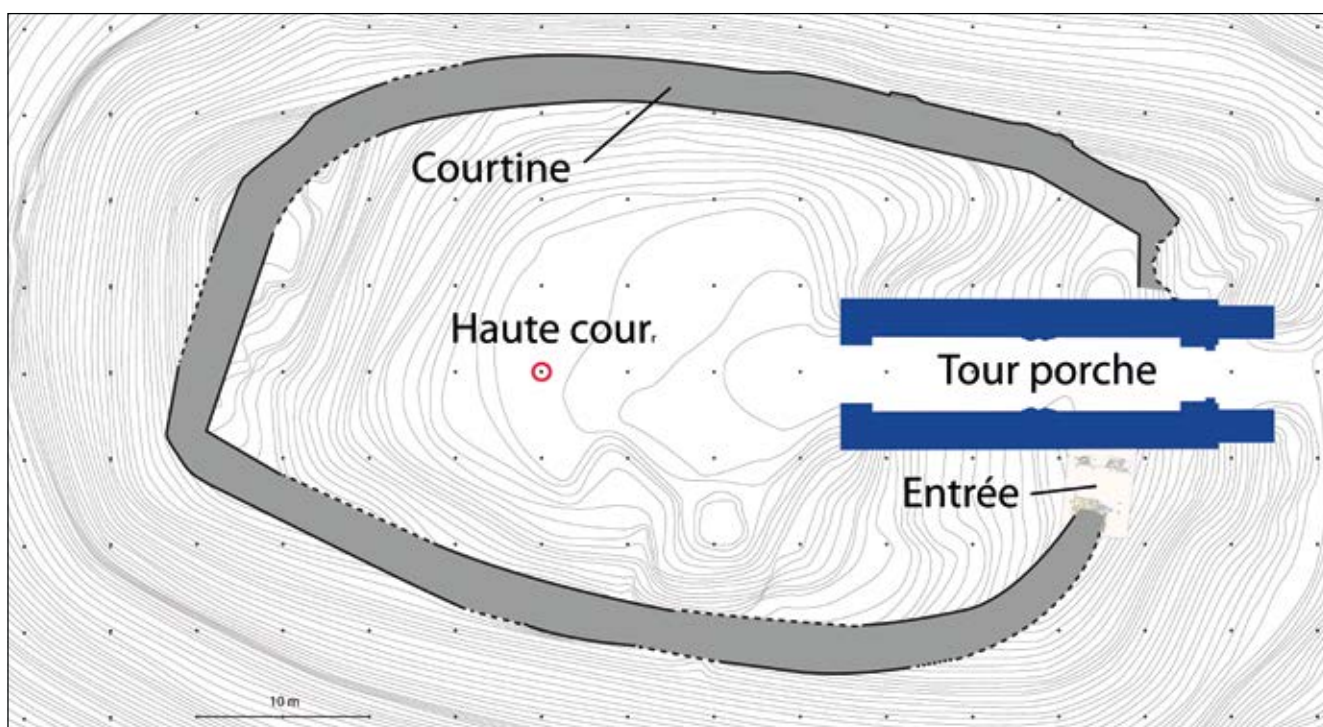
LA POMMERAYE, Château Ganne. Plan de la haute cour.
